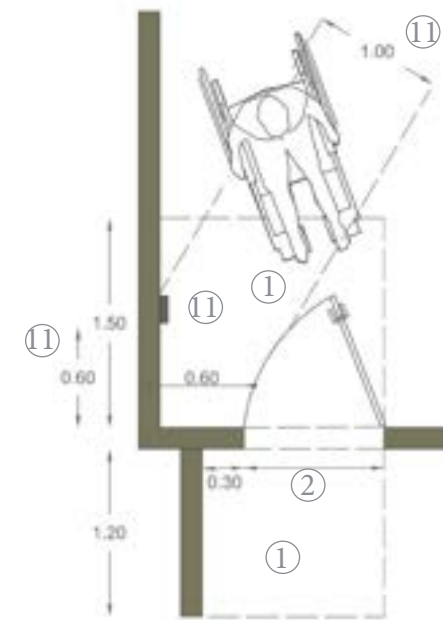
2 Dispositivo de accionamiento - Planta
